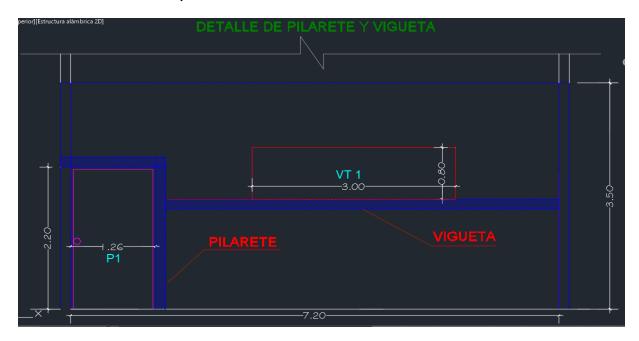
detalle de cálculo de pilarete y vigueta Fuente: Kevin Ronald Armas Padilla
